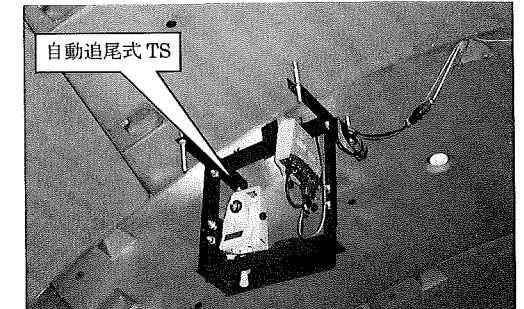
自動追尾式TS設置状況(上部設置)(セグメント内径：φ6,700mm)
